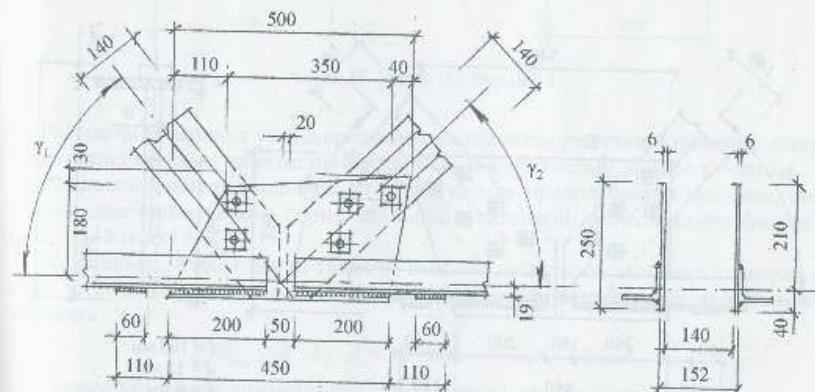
Промежуточный узел нижнего пояса. Вариант 1
